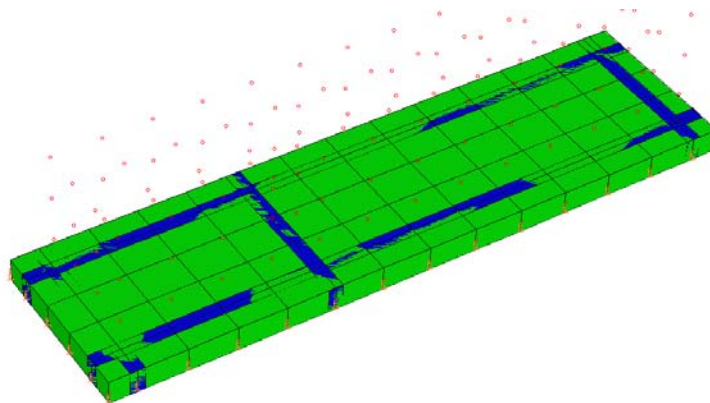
Vista 3D Platea di Fondazione con Travi di Collegamento
